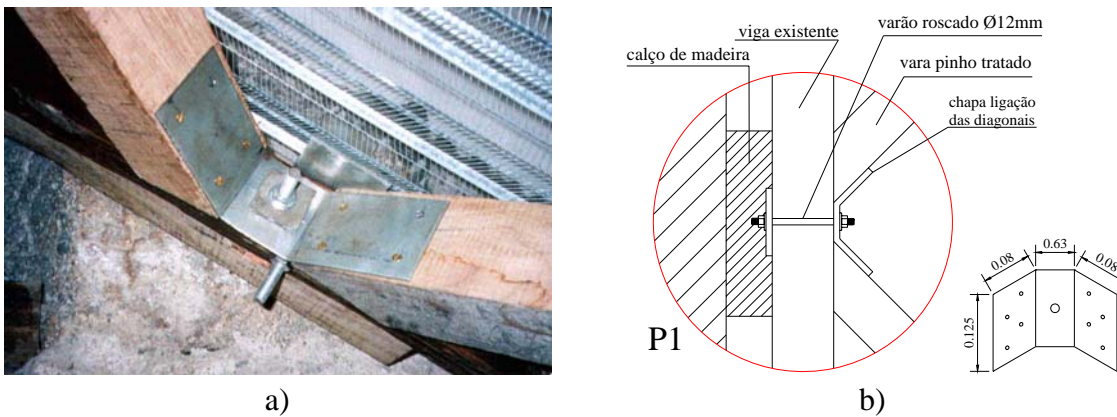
a) [4e] Chapa de ligação das diagonais às vigas de madeira existentes
